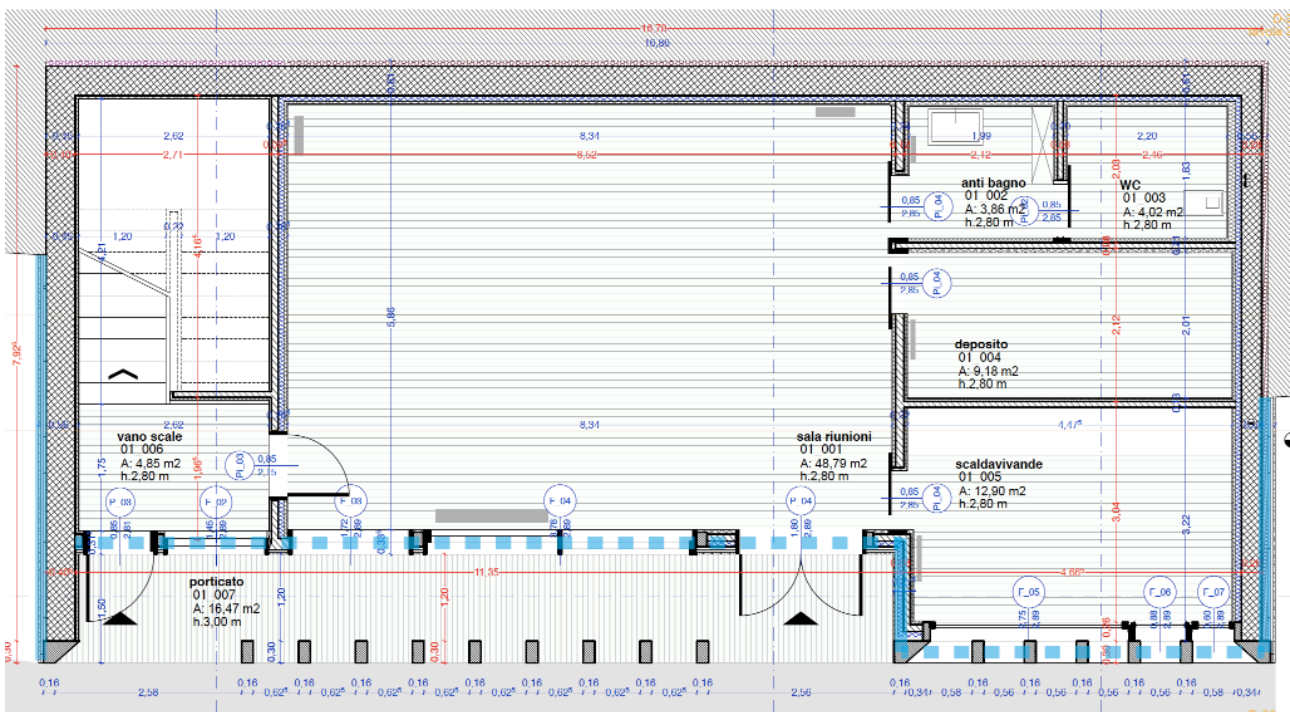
Pianta piano primo. Parete tipo 1 in Rosso, Parete tipo 2 in blu
